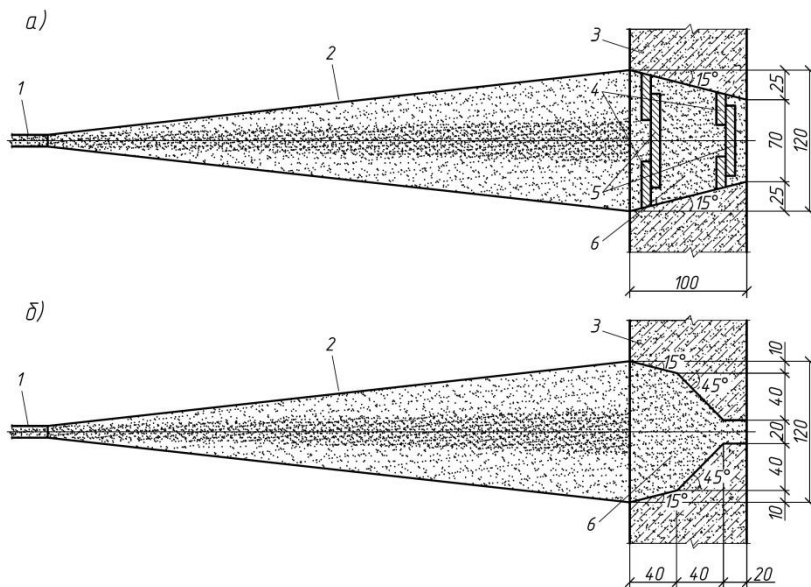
Формы стыков несъемной железобетонной опалубки при их замоноличивании способом мокрого торкретирования: а) стык армированный; б) стык неармированный; 1 - сопло; 2 - струя торкрета; 3 - тонкостенный железобетонный элемент несъемной опалубки; 4 - арматурные выпуски; 5 - накладки для сварки арматурных выпусков; 6 - полость стыка тонкостенных железобетонных элементов, которая заполнена мелкозернистым бетоном
